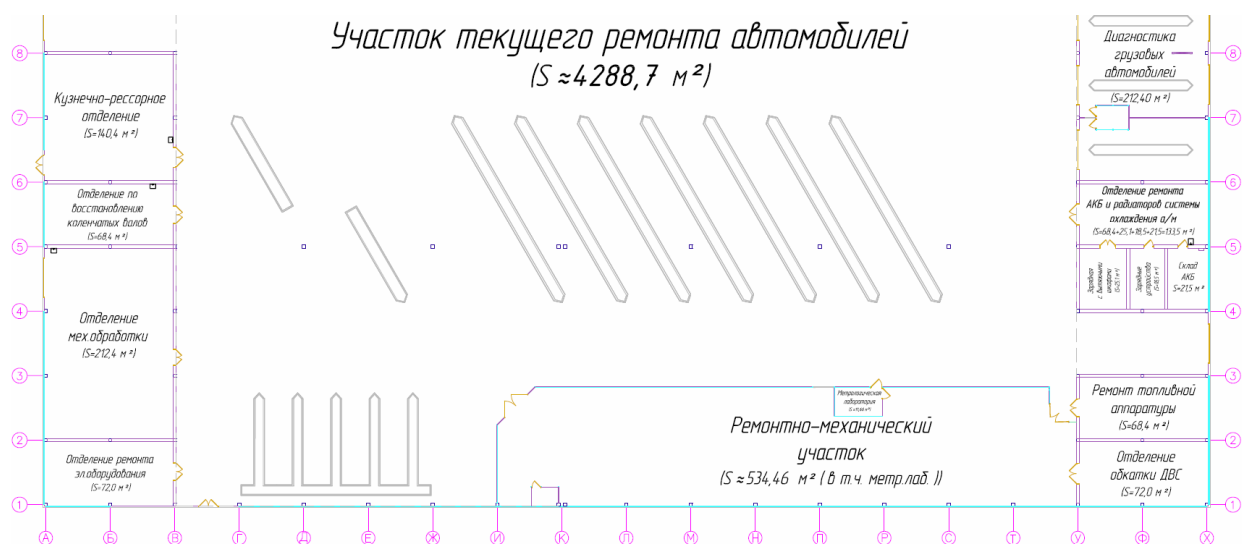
Фрагмент схемы АРМ до проведения строительных работ
